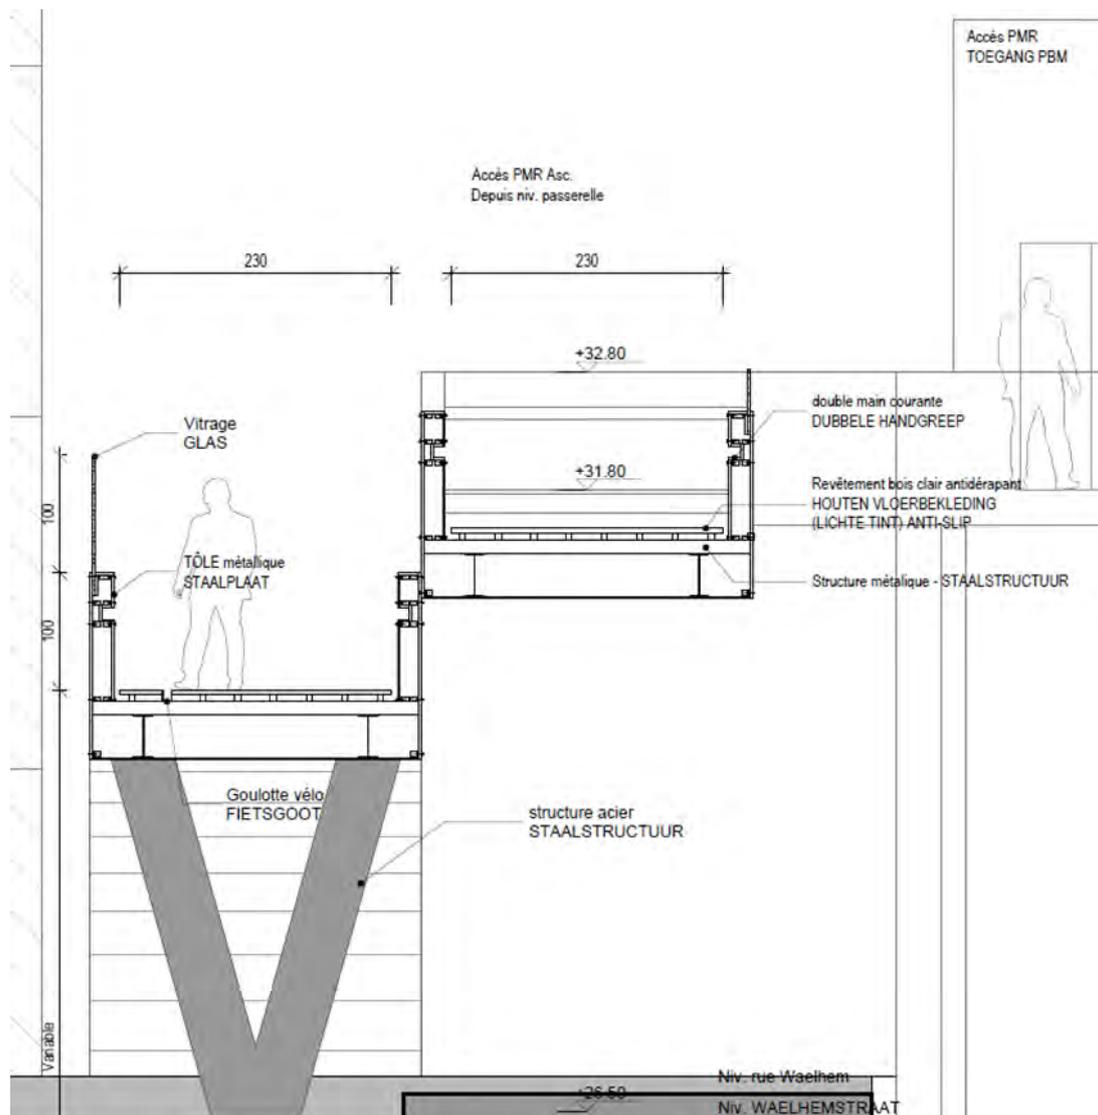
Coupe transversale de la passerelle (BMN, 2018)
